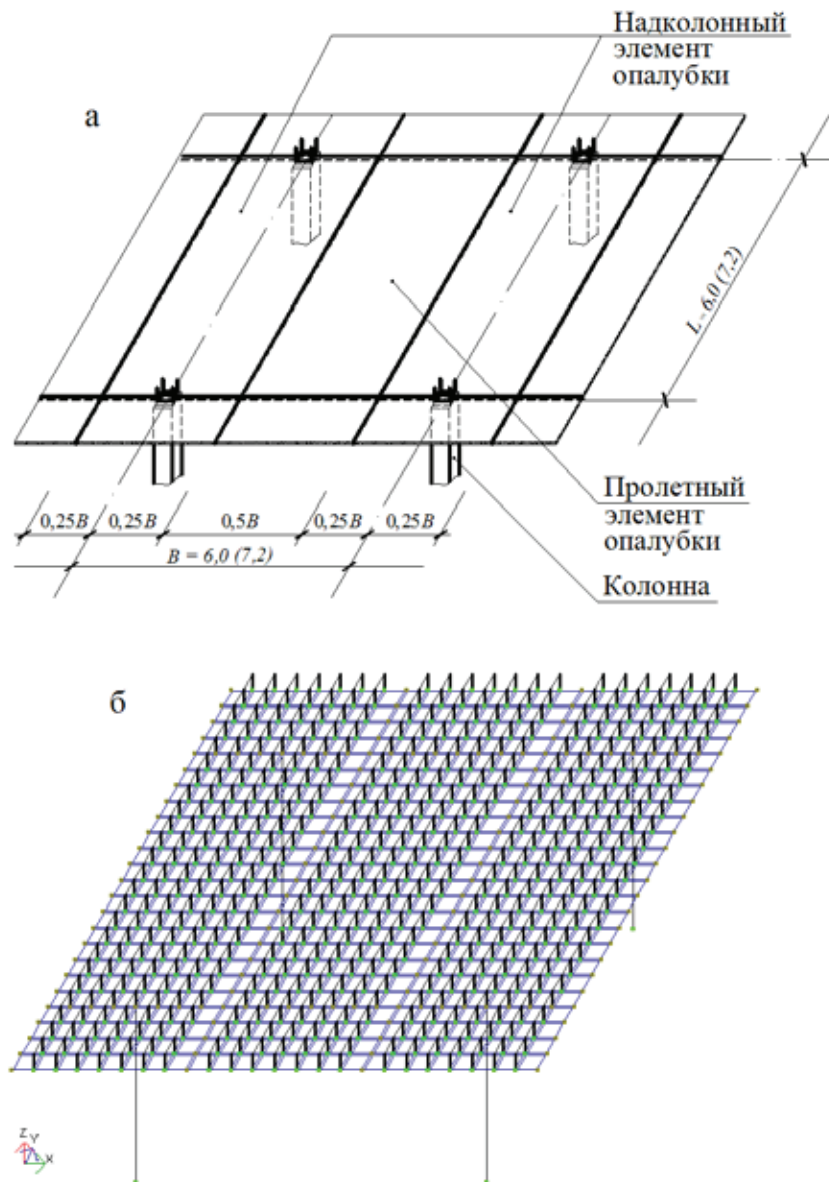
Принципиальная схема фрагмента сборно-монолитного перекрытия: а – фрагмент ячейки каркаса; б – расчетная конечно-элементная модель
